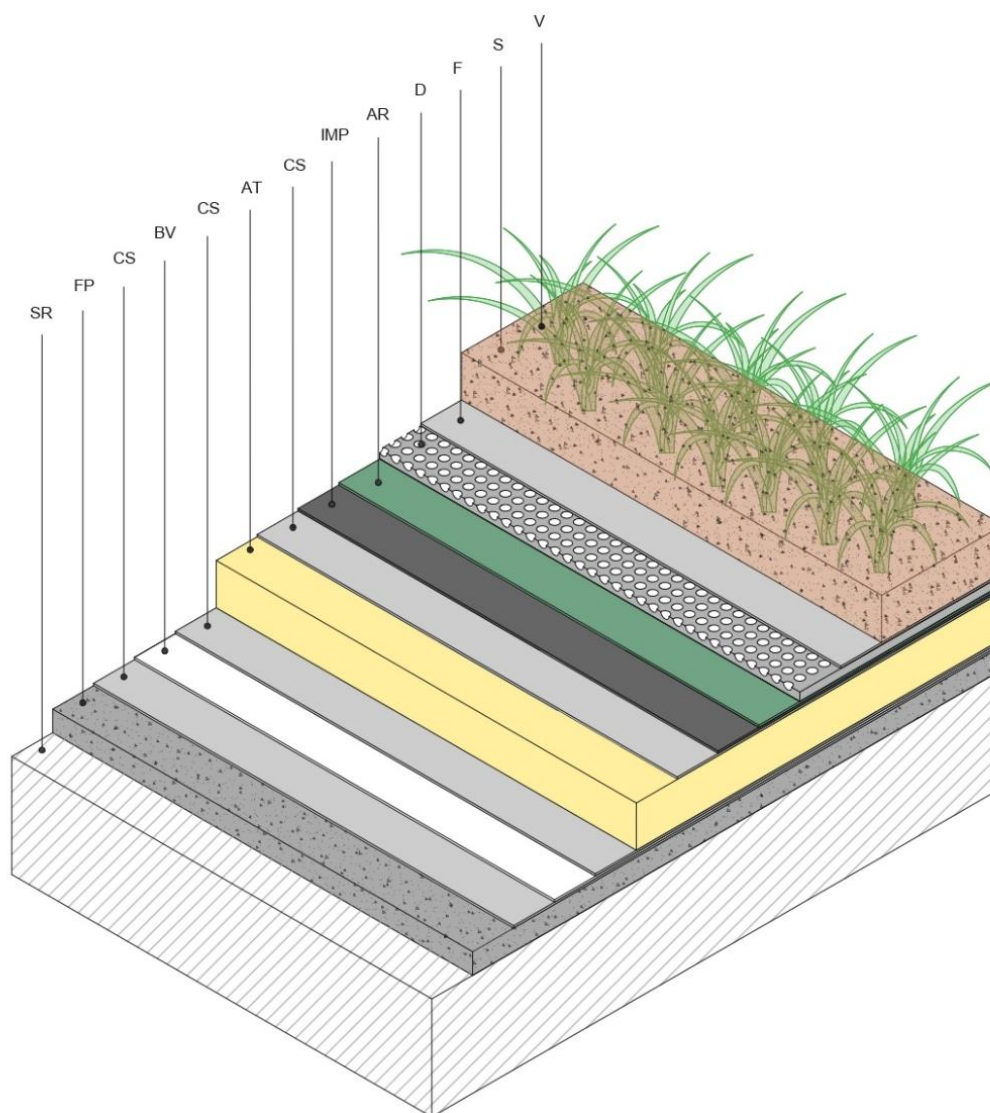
Detalle constructivo colocación capa antiraíces cubierta convencional. Leyenda: V: Vegetación; S: Sustrato; F: Capa separadora filtrante; D: Capa separadora drenante; AR: Capa separadora antiraíces; IMP: Lámina impermeabilizante; AS: Aislante; CS: Capa separadora; BV: Barrera contra vapor; FR: Formación de pendiente; SR: Soporte.
